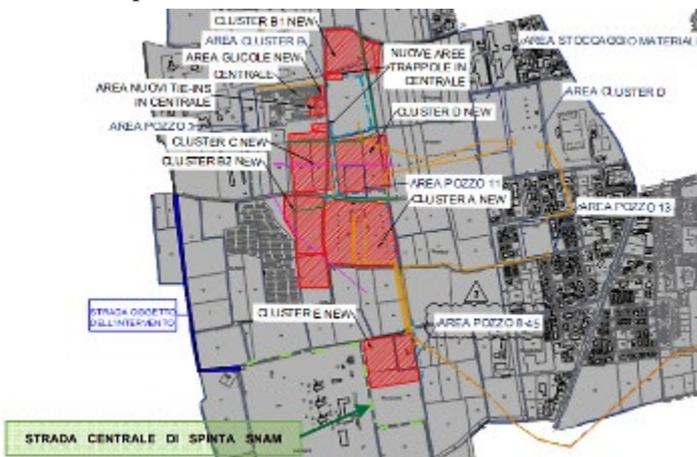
Panoramica dell'area interessata dal progetto con indicazione della strada oggetto dell'intervento di adeguamento (in blu) e della viabilità esistente della Centrale di spinta di Snam Rete Gas (in verde), che sarà utilizzata per la cantierizzazione del progetto
